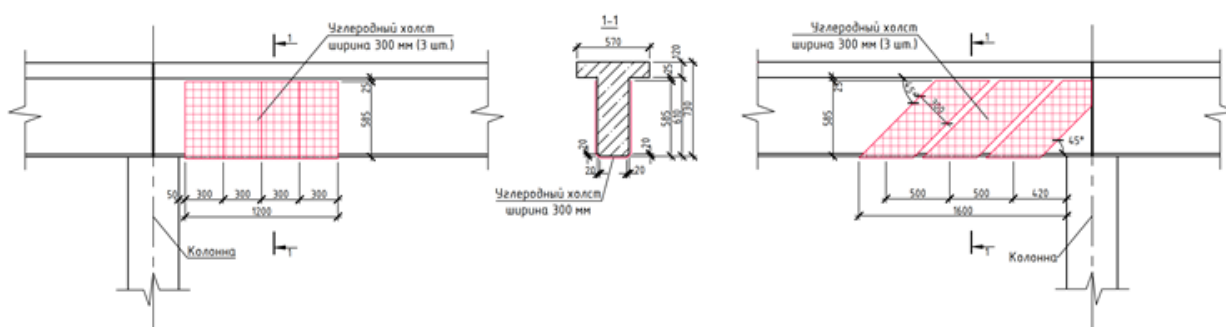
Схемы усиления опорных частей балки углеродными лентами
